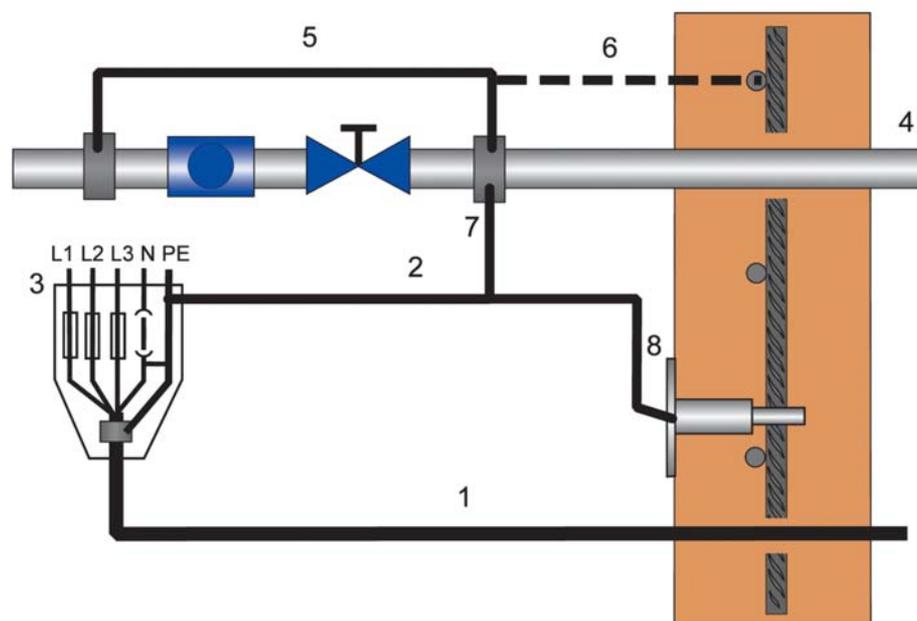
Collegamento del dispersore alternativo (8) e spostamento del collegamento del cavo di messa a terra lungo la condotta dell'acqua (7).
